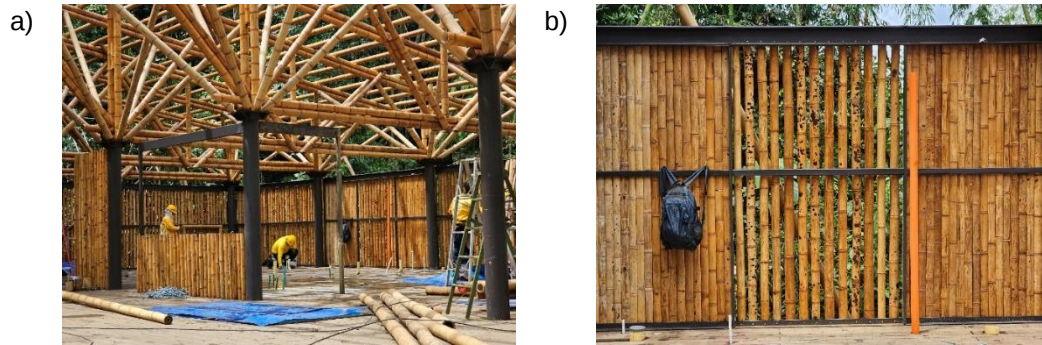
a) Estructura metálica y guadua y b) Tipología de fachada. Elaboración propia.
